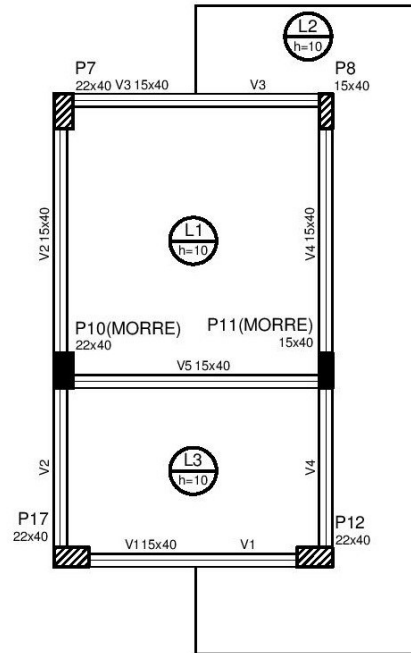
Planta de formas do projeto estrutural: Cobertura
